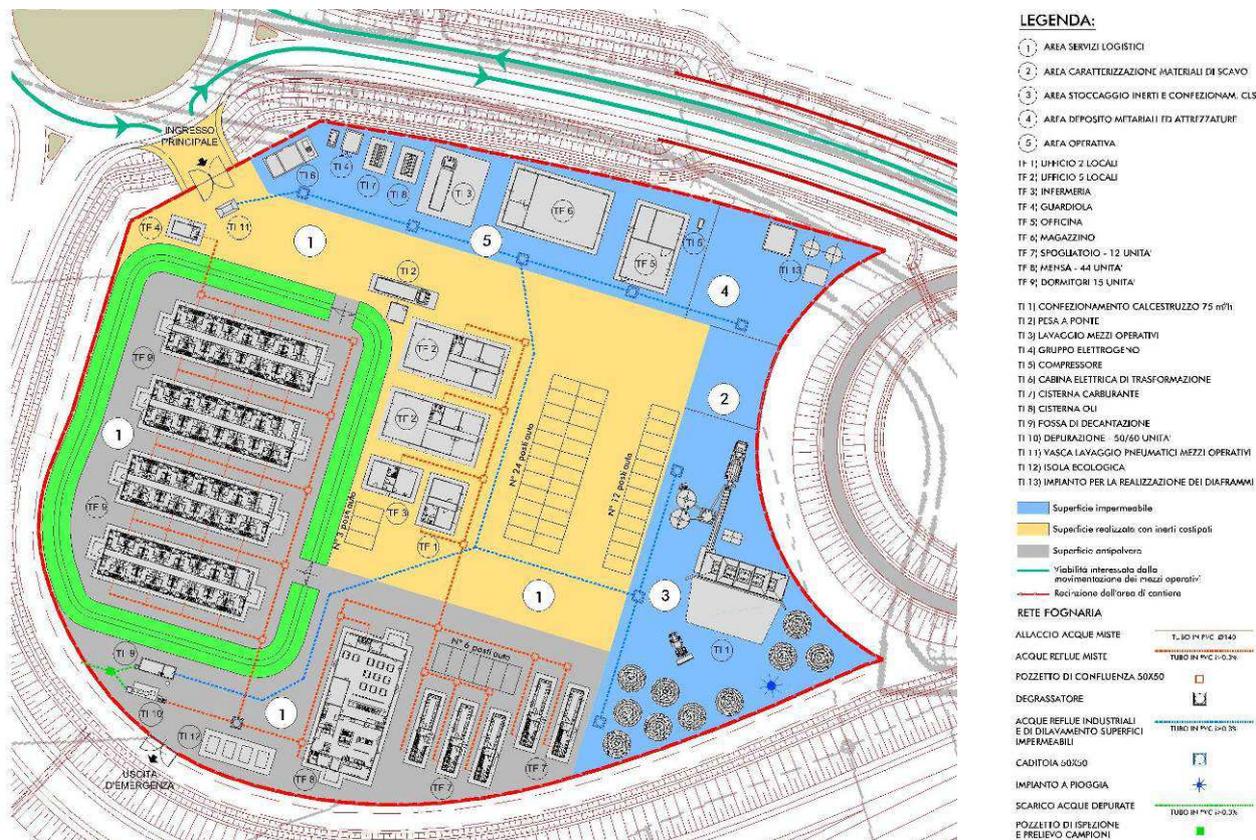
LAY-OUT DEL CAMPO BASE C-B (ESTRATTO DALL'EAB. T00CA00CANLF01A- TAV. 06.1).
